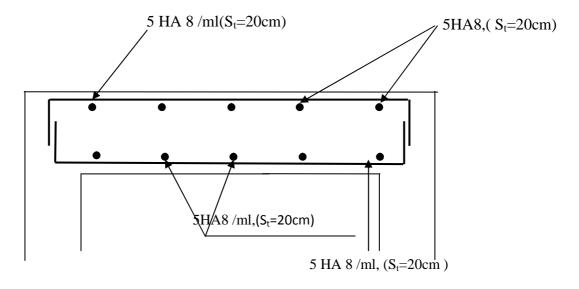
Ferraillage de la dalle pleine de la salle machinedans le sens x-x.
